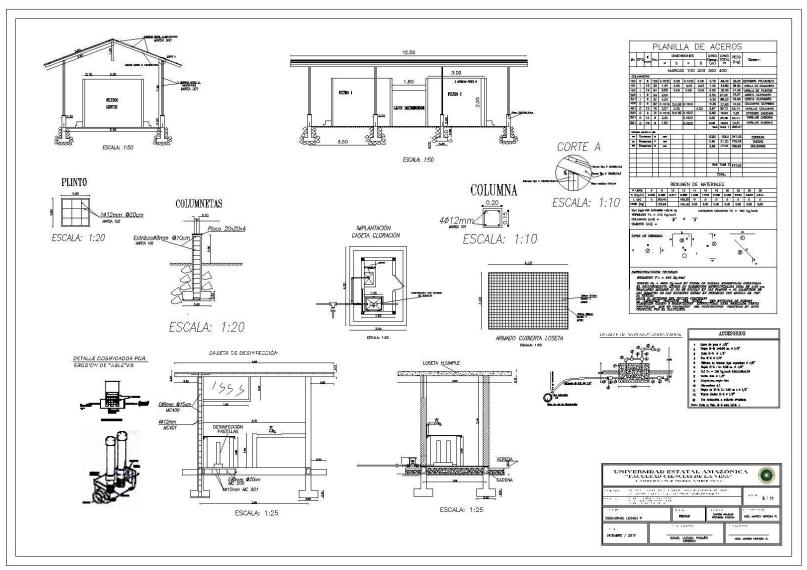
Detalle de la casa de desinfección, cubierta de filtros detalles estructurales.
